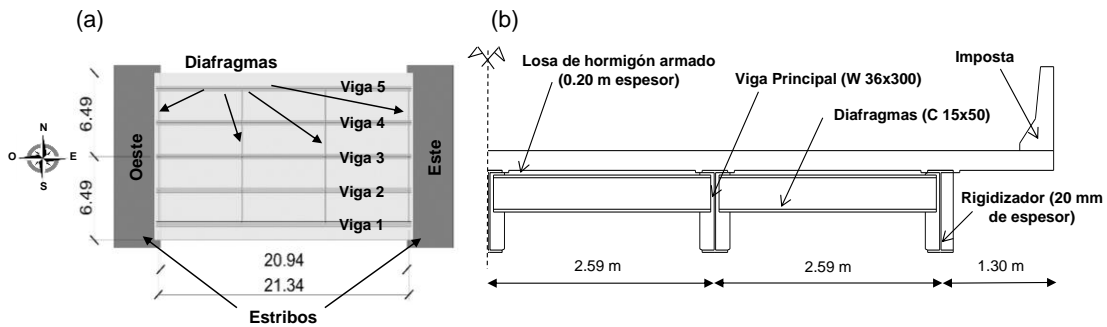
Geometría del puente de 21.34 m. a) Vista en planta sin la losa de hormigón. b) Sección del puente.
